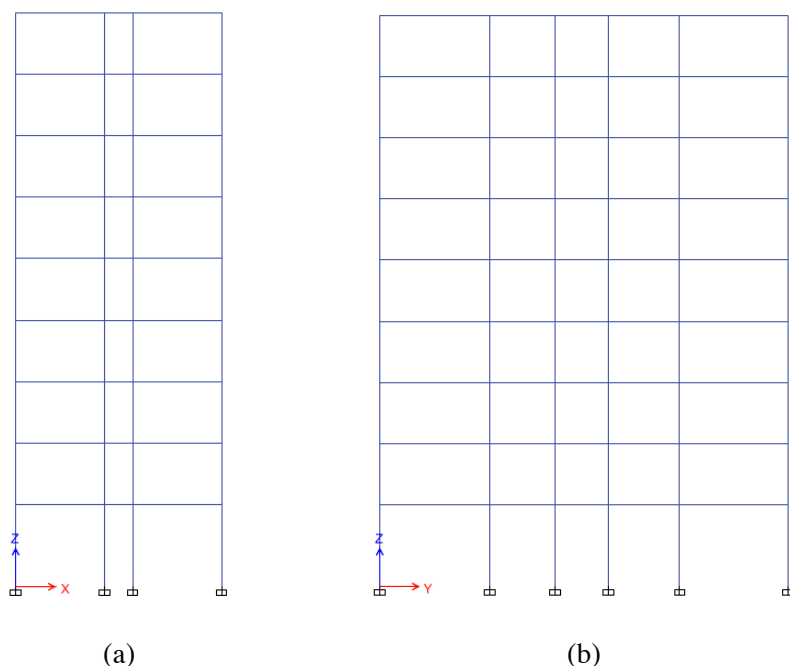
Edificio tipo 9U-S y 9U-C. (a) Alzado. (b) Perfil
